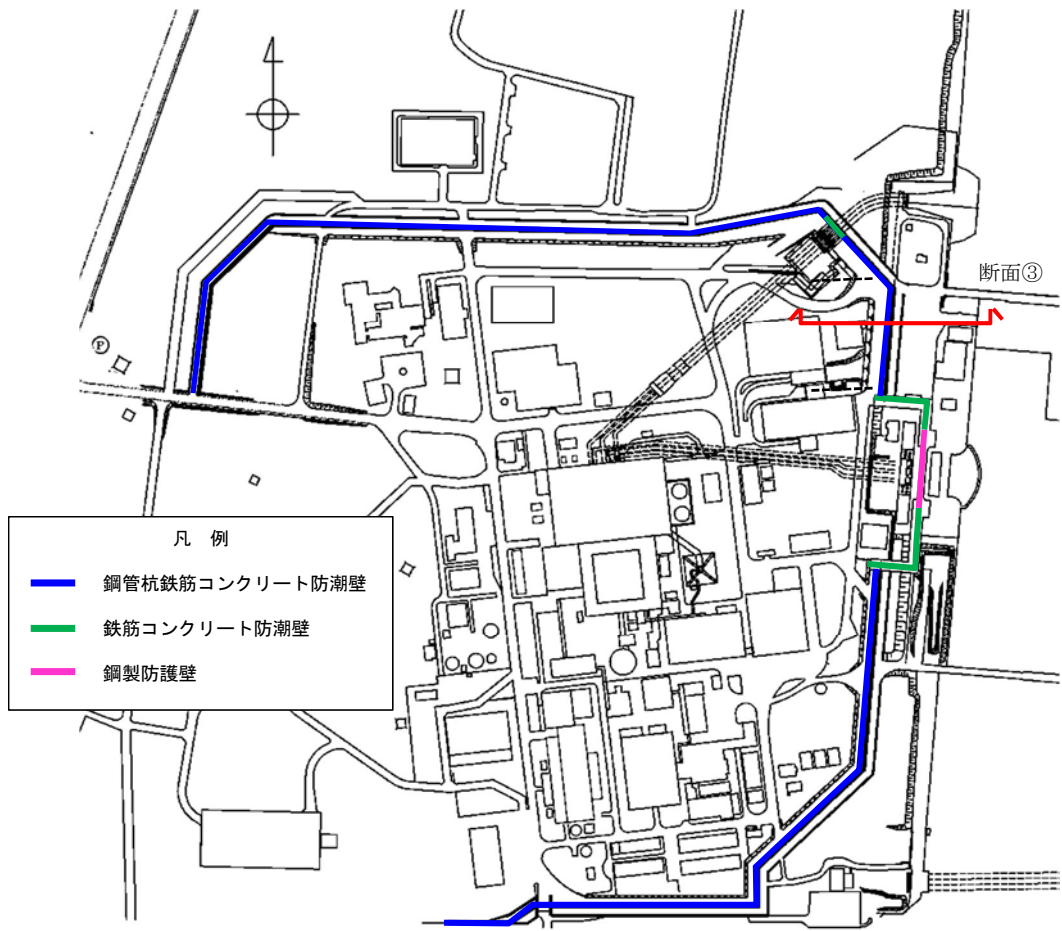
鋼管杭鉄筋コンクリート防潮壁及び評価断面の位置
